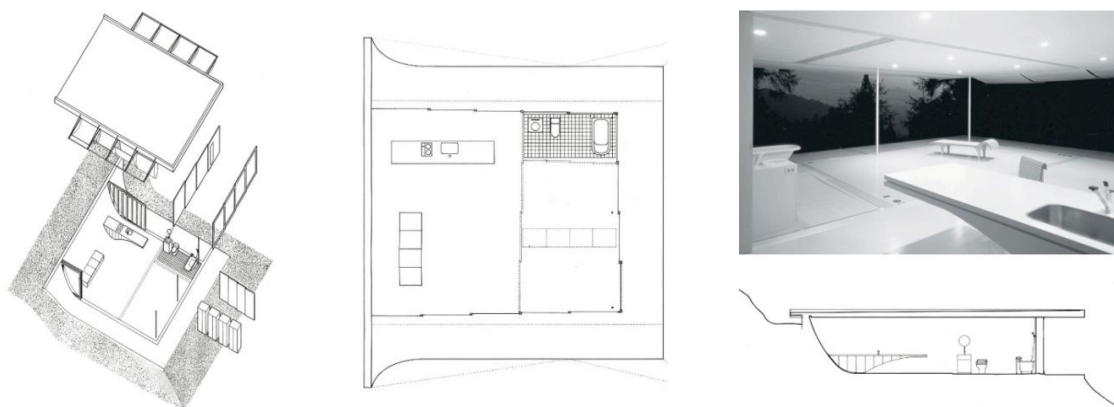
Wall-less House*, axonometria, planta e corte.
